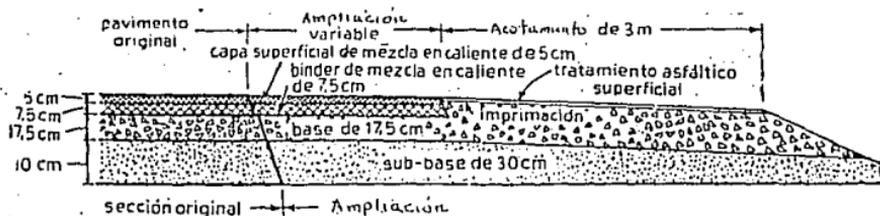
Empleo de una continuación de la sección primitiva para la ampliación de un pavimento de tipo flexible.
